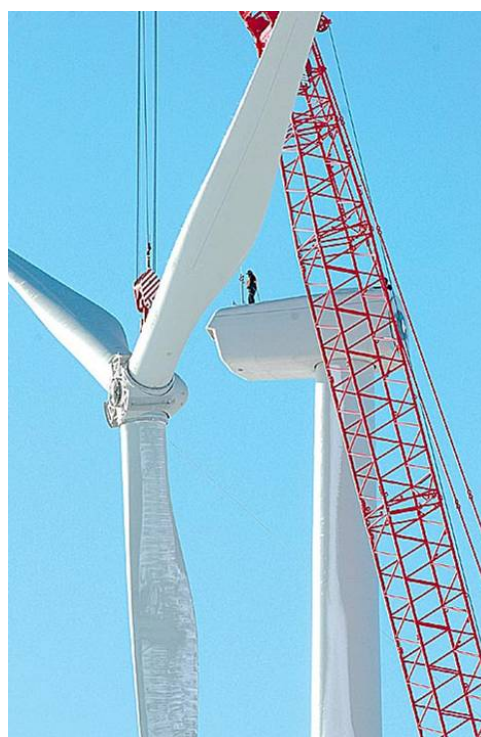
Installazione della turbina: montaggio del rotore.
